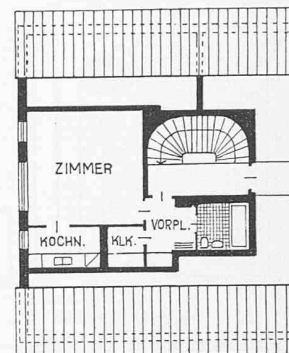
Im Giebel eingebaute Einzimmer-Wohnung
